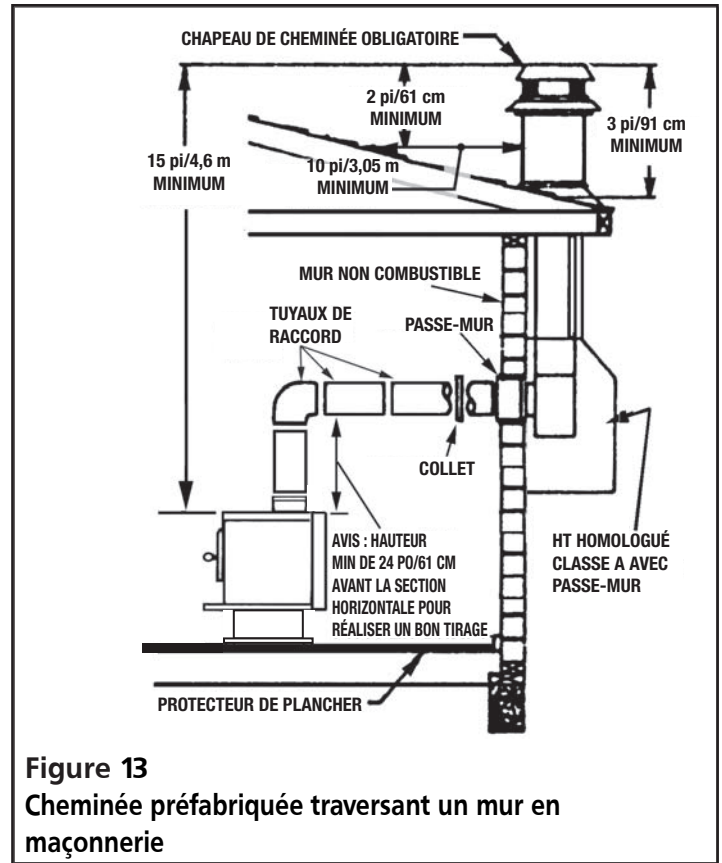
Cheminée préfabriquée traversant un mur en maçonnerie
